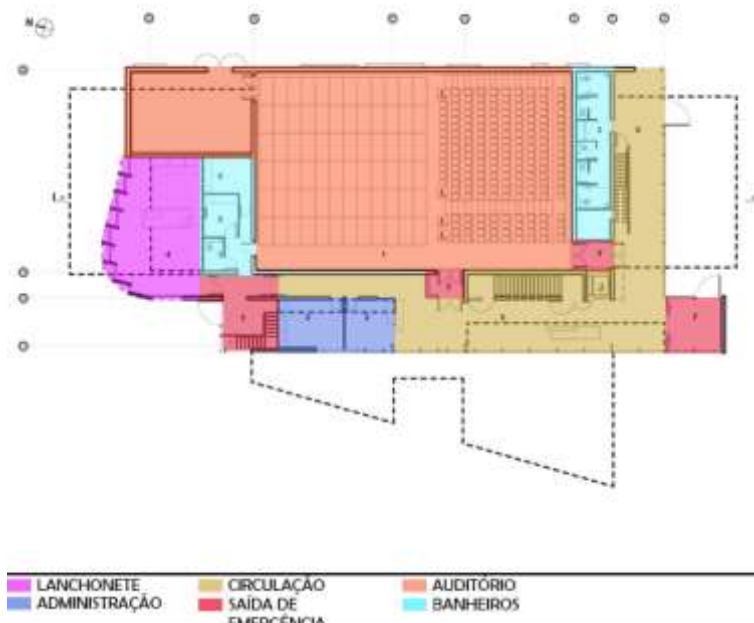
Primeiro pavimento Centro Cultural de Sedan
